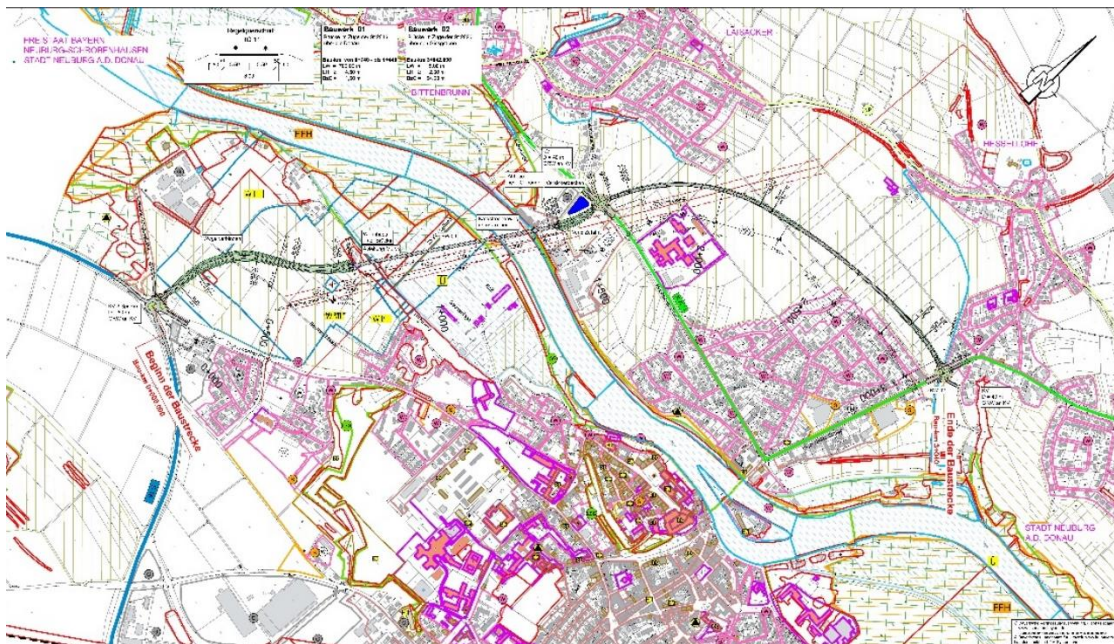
Planfall VII – Westtangente zwischen B16 und St 2214 mit Verlängerung zur Ingolstädter Straße (Mittellage)
